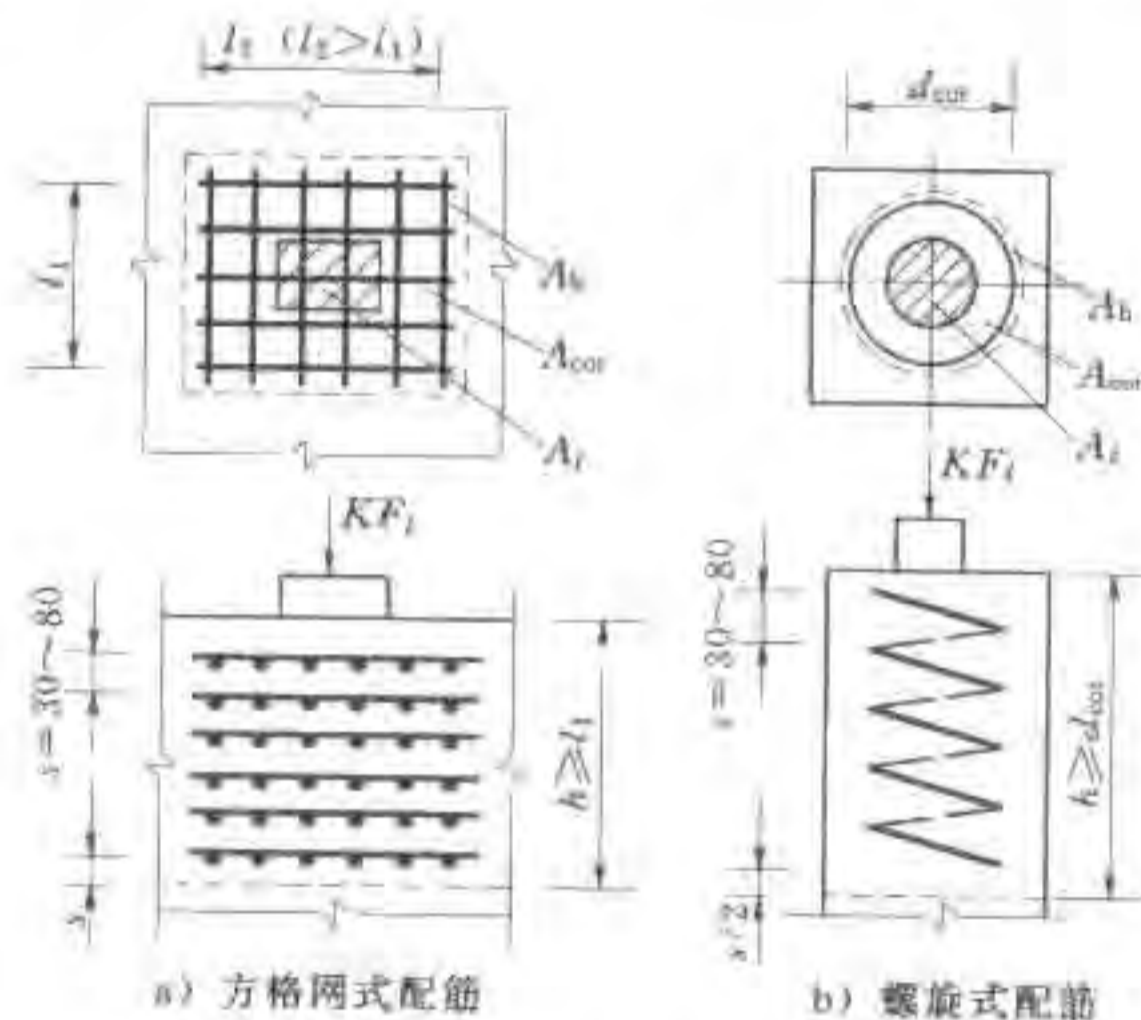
局部受压区间接钢筋的配置 (单位: mm)
